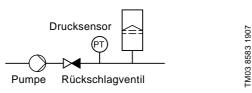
Position des Rückschlagventils und des Drucksensors in Anlagen mit positivem Vordruck
